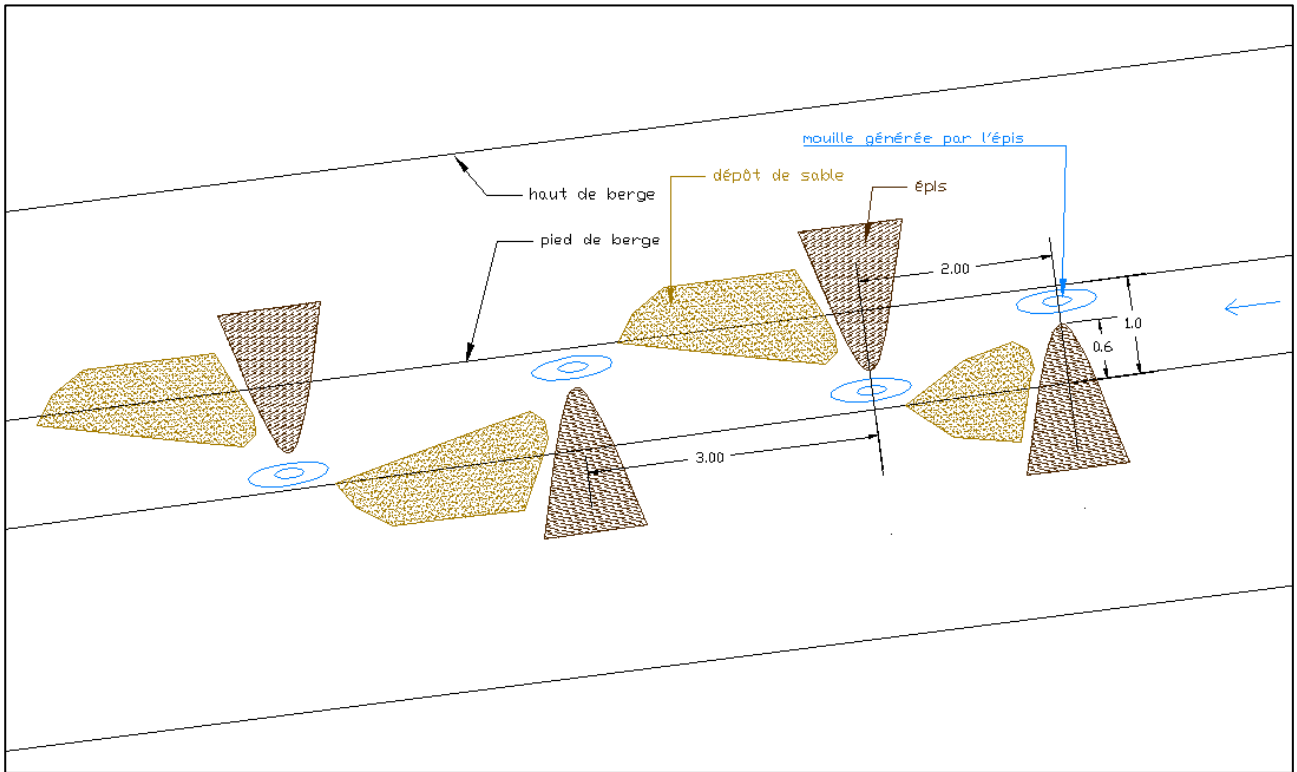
vue en plan du positionnement possible des épis sur le Vigneau
